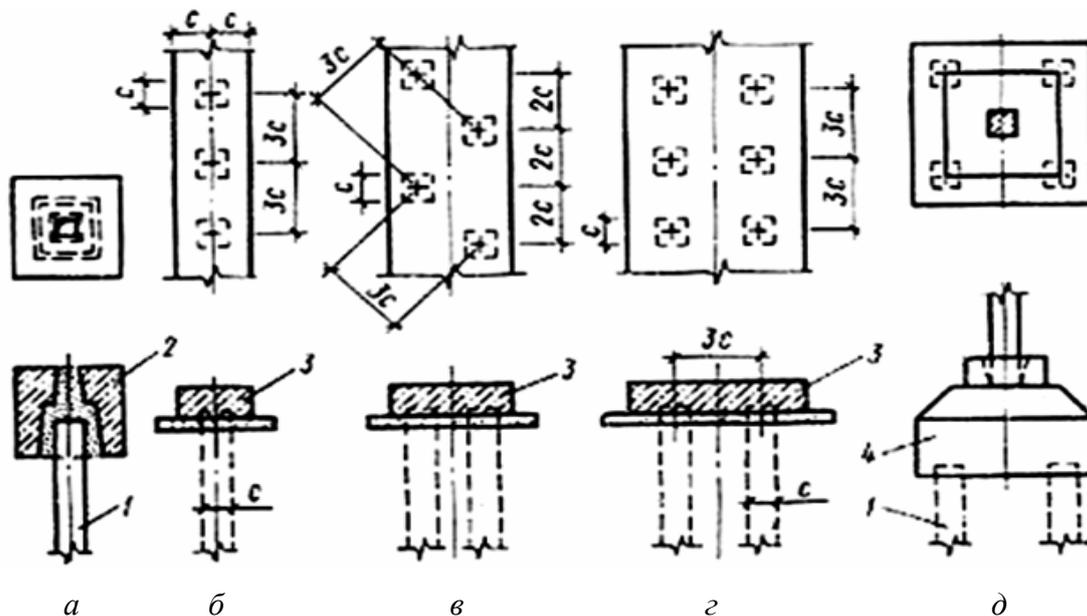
Расположение свай: *a* — сопряжение сборного оголовка под одиночную сваю; *б* — однорядное расположение свай; *в* — шахматное расположение свай; *г* — двухрядное расположение свай; *д* — куст свай под одиночную колонну: 1 — свая; 2 — сборный оголовок; 3 — монолитный железобетонный ростверк; 4 — железобетонный ростверк под колонну
